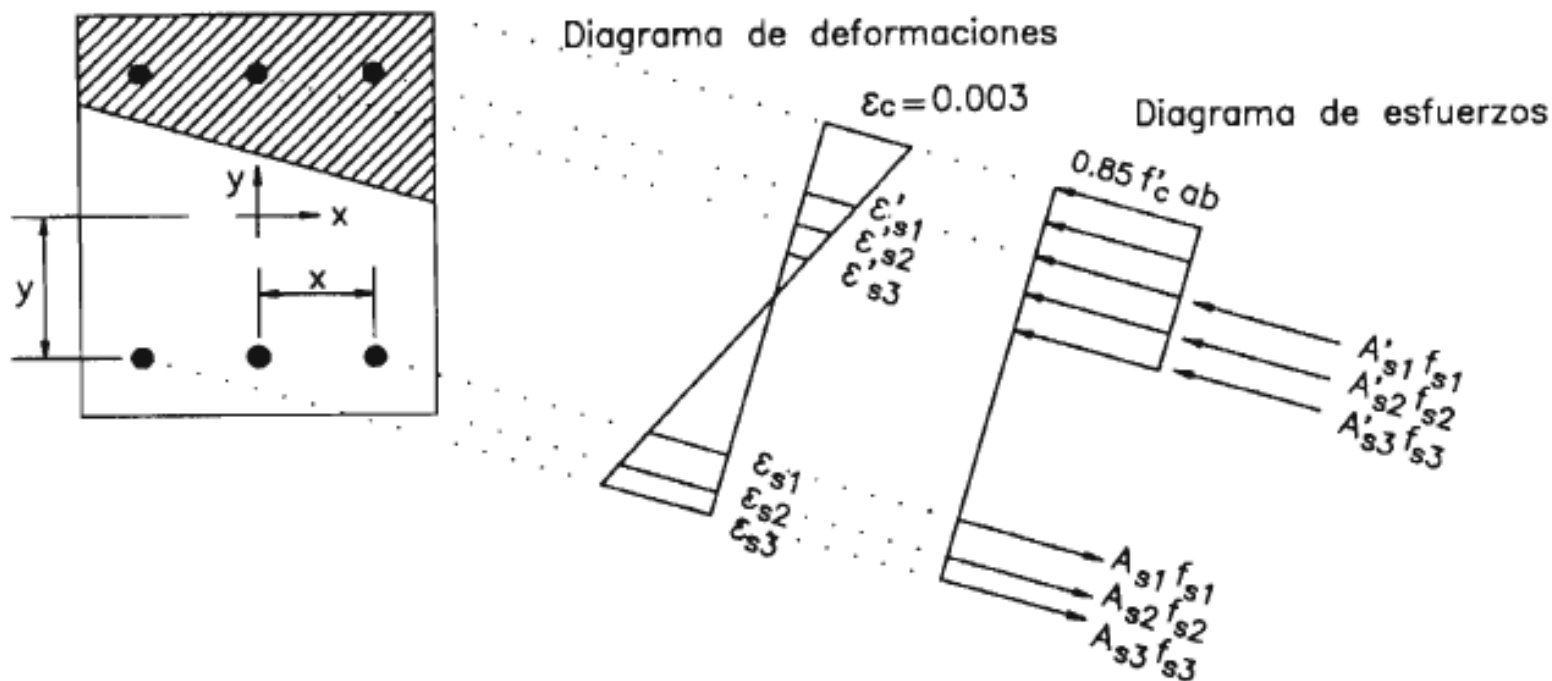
Esfuerzos y deformaciones en una sección de una columna sometida a flexión biaxial
